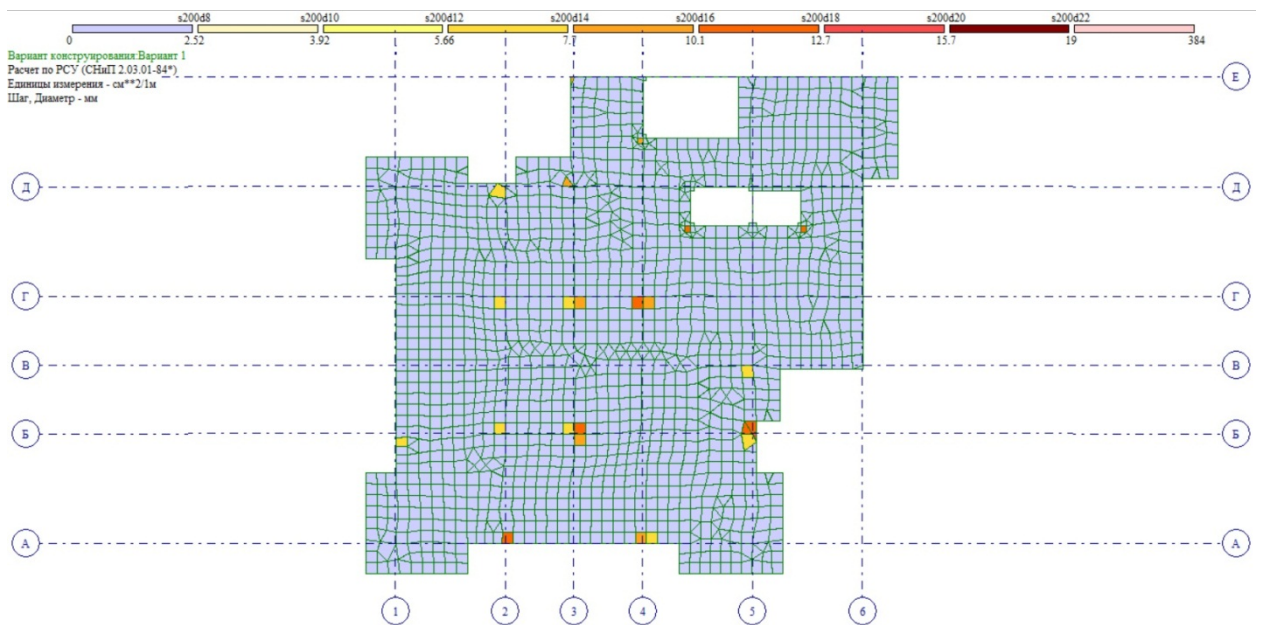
Поперечное армирование плиты вдоль оси Х
